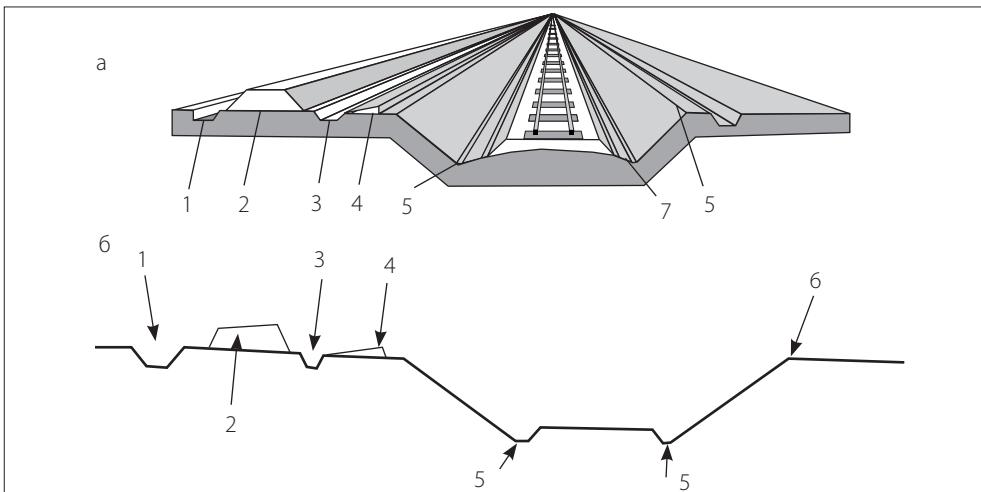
Поперечный профиль выемки. Выемка (а) и ее типовой поперечный профиль (б) (размеры приведены в метрах): 1 — нагорная канава; 2 — кавальер; 3 — забанкетная канава; 4 — банкет; 5 — кювет; 6 — бровка откоса; 7 — обочина; bon — ширина основной площадки земляного полотна
